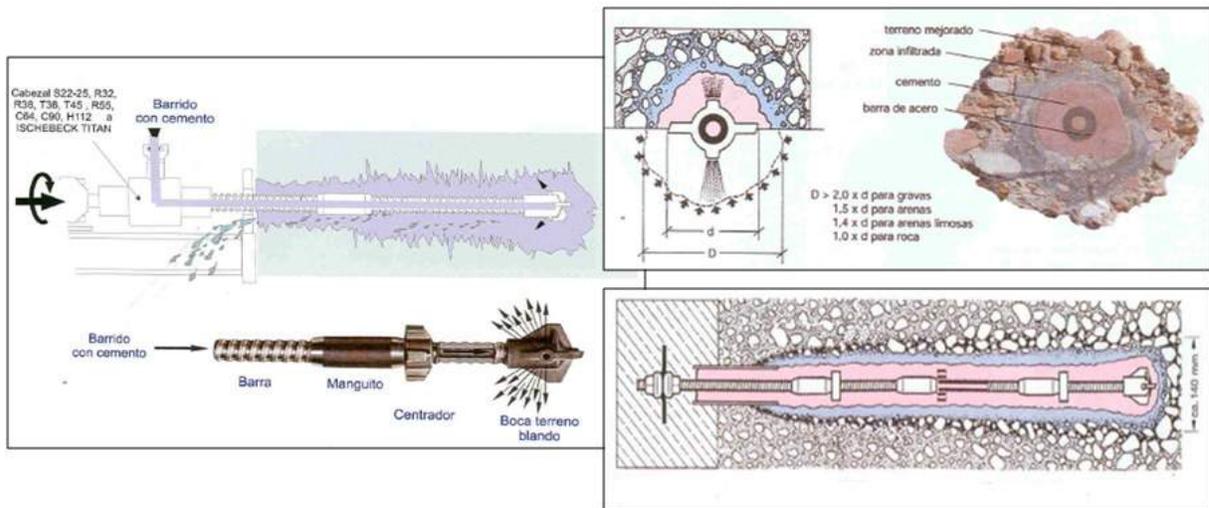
Detalle constructivo de los anclajes pasivos del tipo TITAN autopercutores
